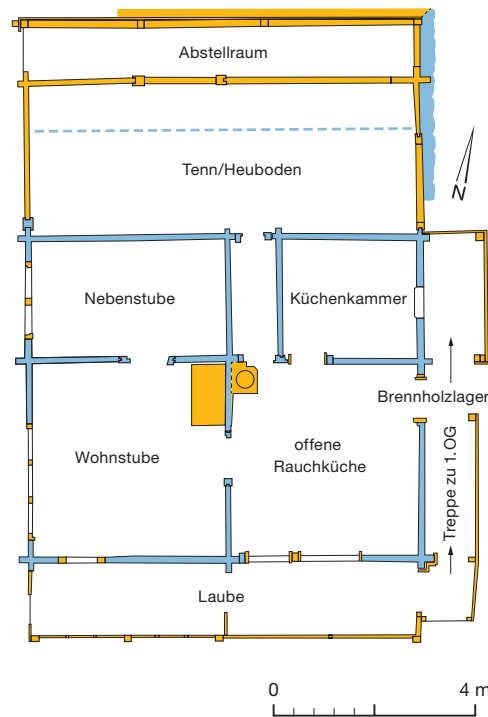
Adelsboden, Hirzbodenportstrasse 10. Grundriss des Stubengeschosses mit der räumlichen Gliederung. Blau ist der ursprüngliche, nahezu quadratische Kernbau dargestellt. In Orange sind die Um- und Erweiterungsbauten des 20. Jahrhunderts gehalten. M. 1:150.
